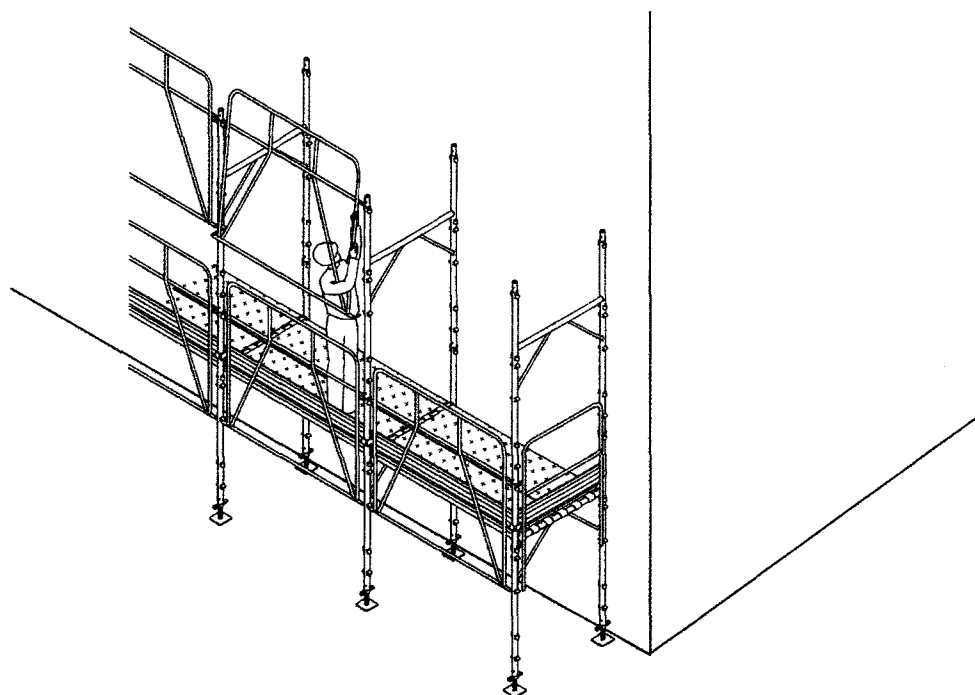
Fasi di montaggio dal basso del ponteggio con parapetto di protezione collettivo
